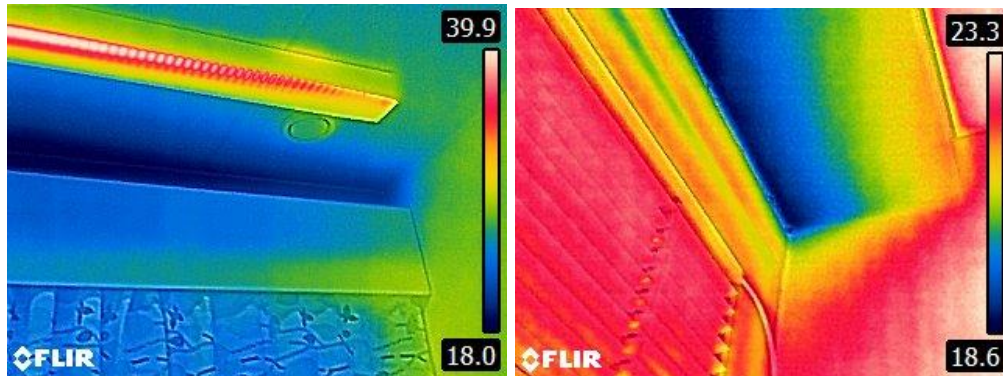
ja 2. Huoneen 25 poistoilmaventtiili on työpisteen kohdalla. Ikkunapenkillä on tavaroita.
